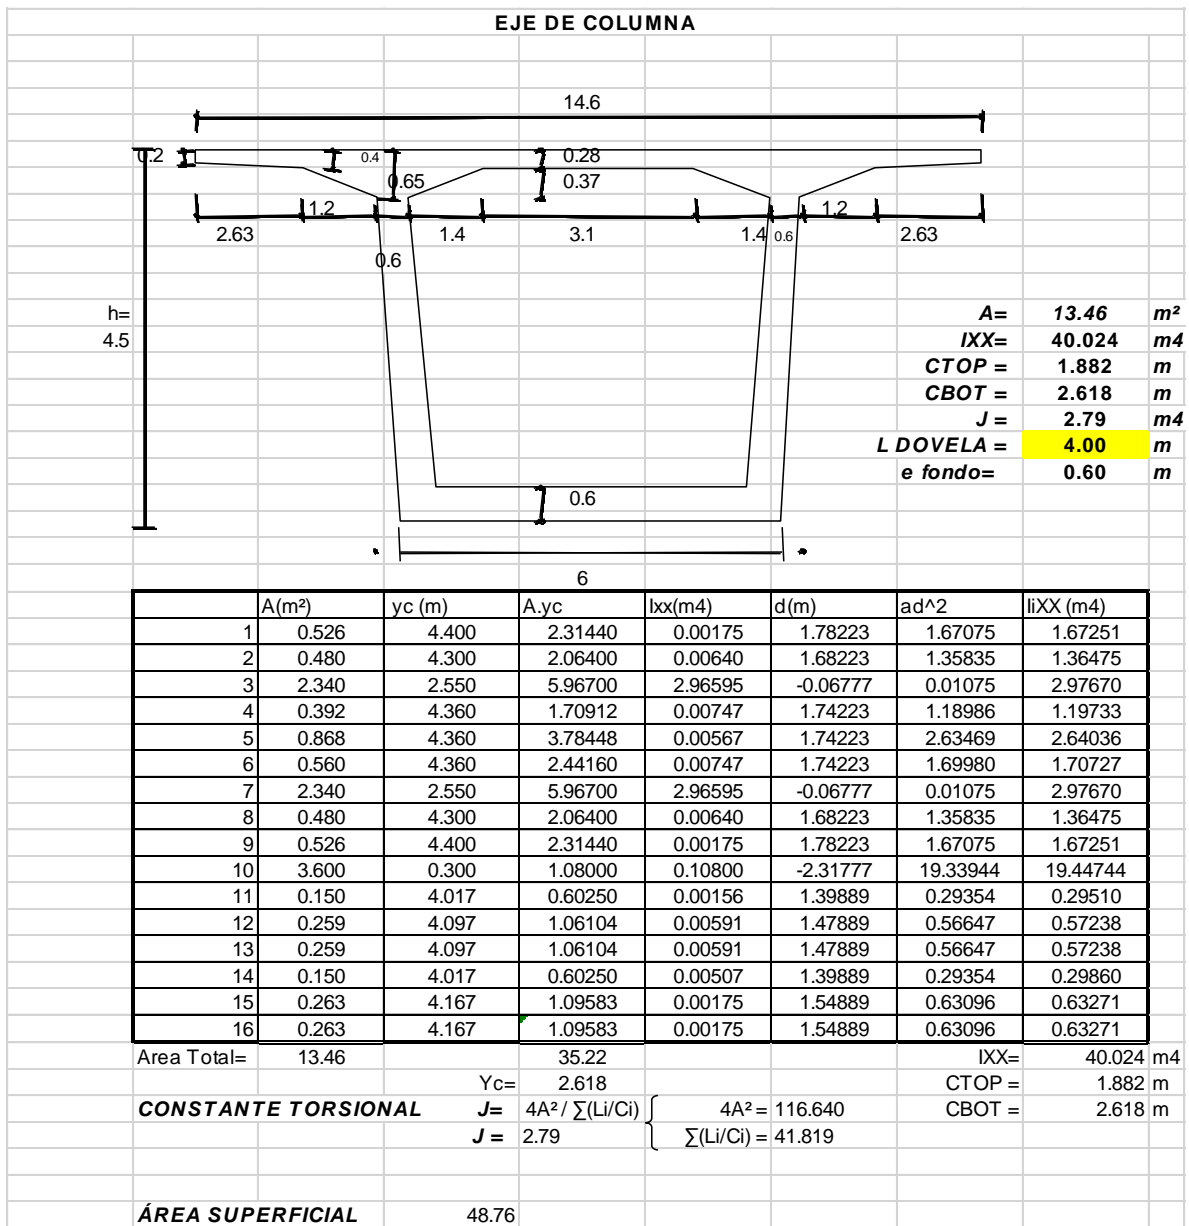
Geometría dovela eje de columna - Puente San Pedro
